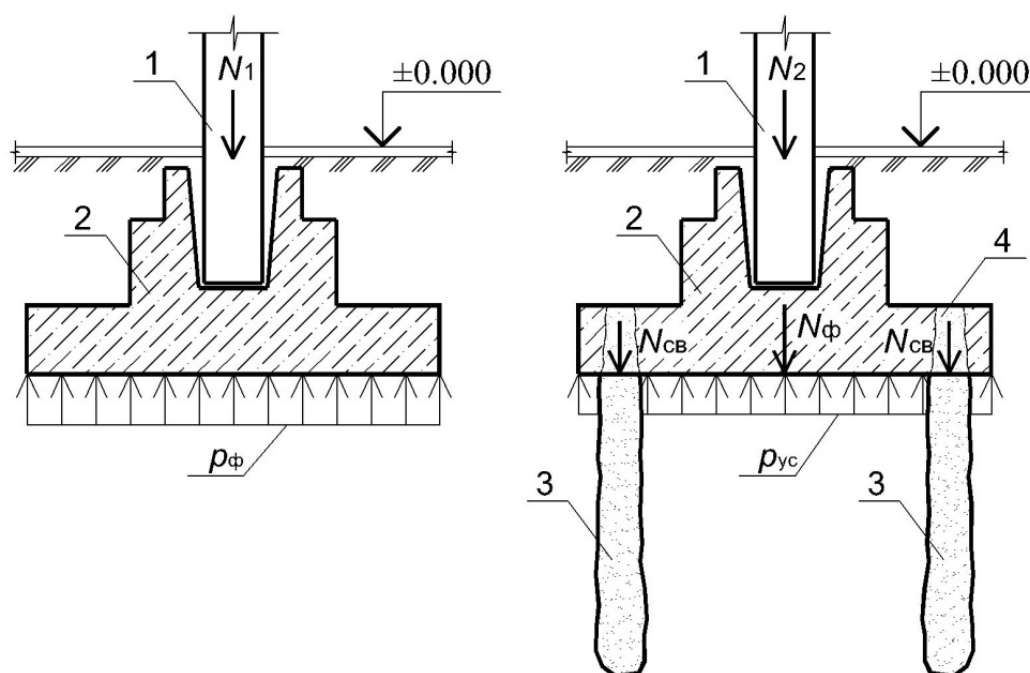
Схема распределения внешней вертикальной нагрузки между конструктивными элементами отдельного фундамента:
